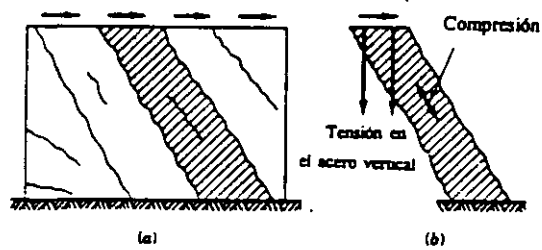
Puntal de compresión entre grietas para muros robustos
